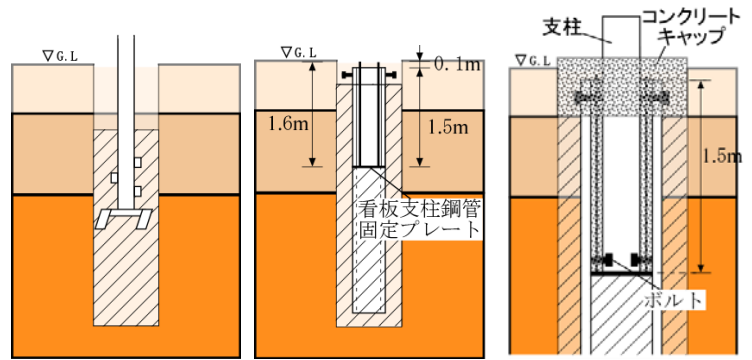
地盤改良体造成(左) 鋼管杭施工(中) 支柱施工(右)
